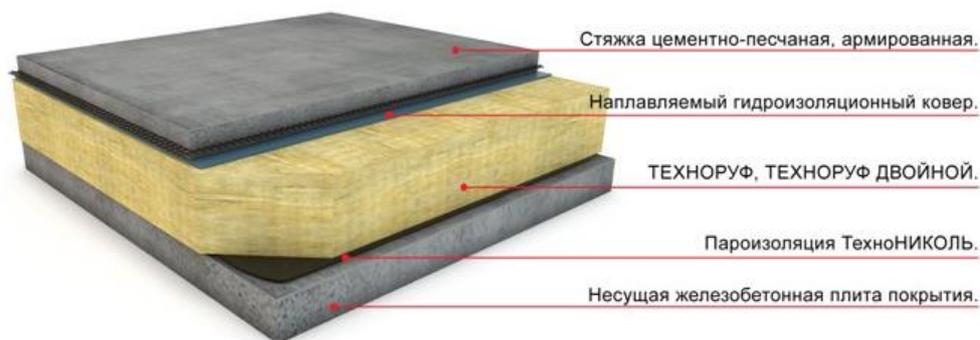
Однослойное теплоизоляционное решение кровли с устройством стяжки
